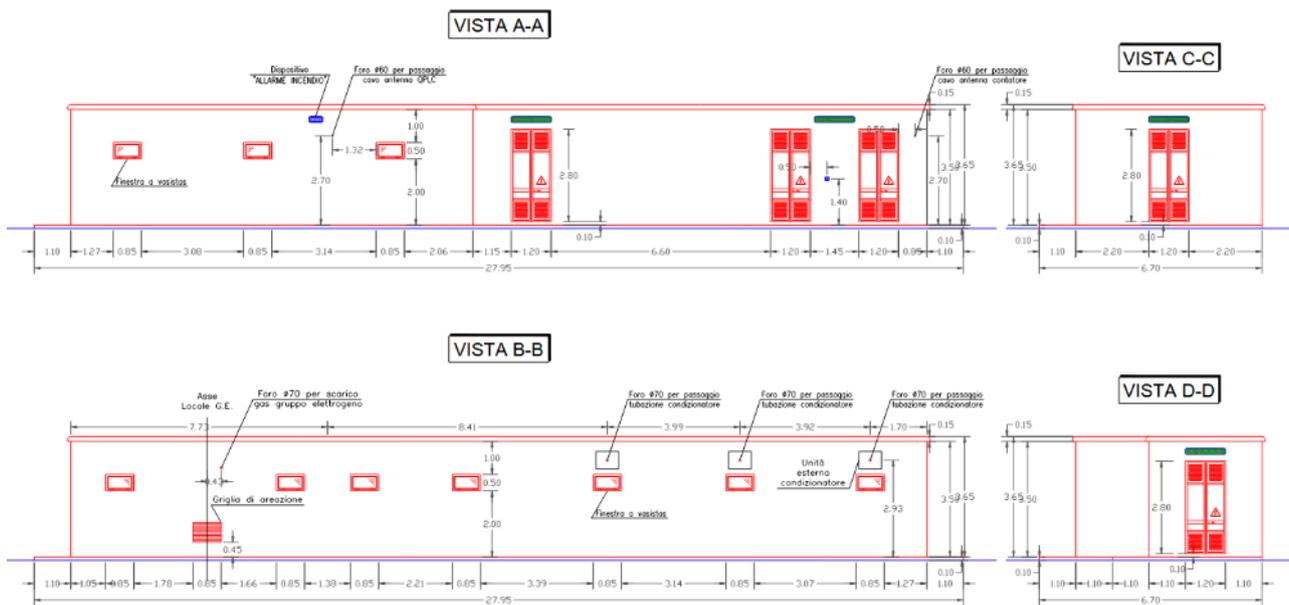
Stazione elettrica di utenza, da elaborati di progetto dell'Ing. Vergelli.
